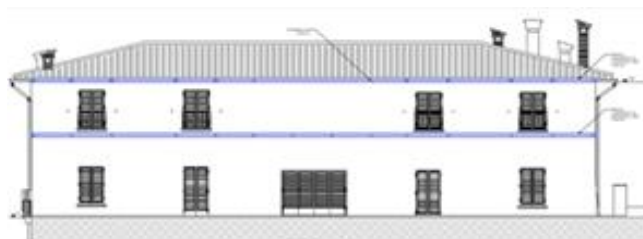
Prospetto frontale con fasce CFRP alla quota dei solai e della copertura.
